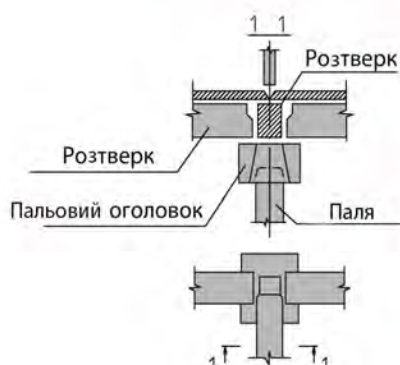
Конструктивний вузол пальового фундаменту з ростверком
